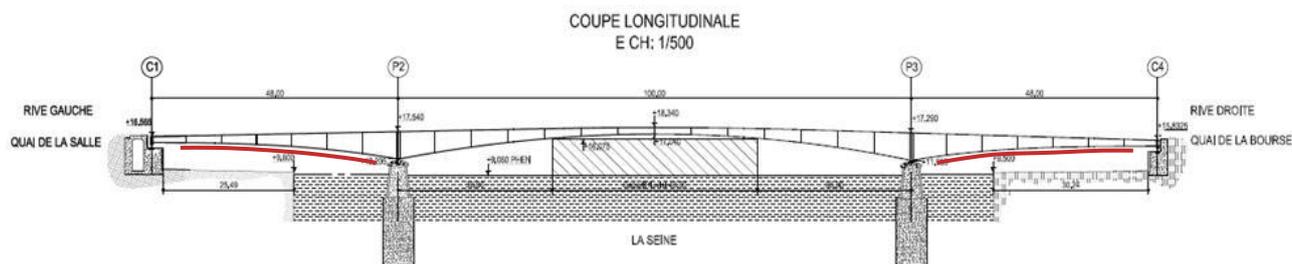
Coupe longitudinale du pont Jeanne d'Arc
